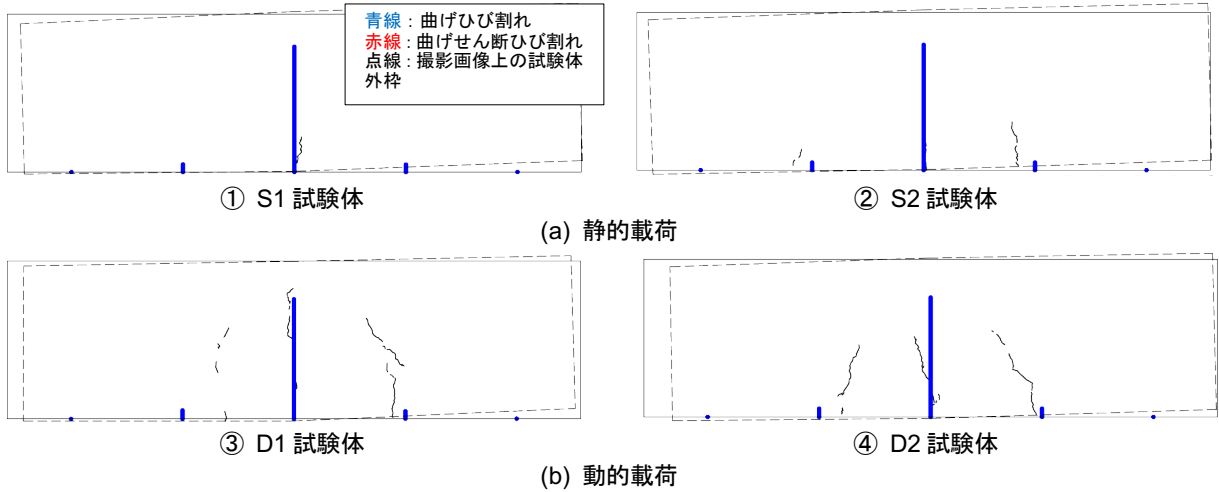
引張鉄筋降伏時のひび割れ図と推定結果
